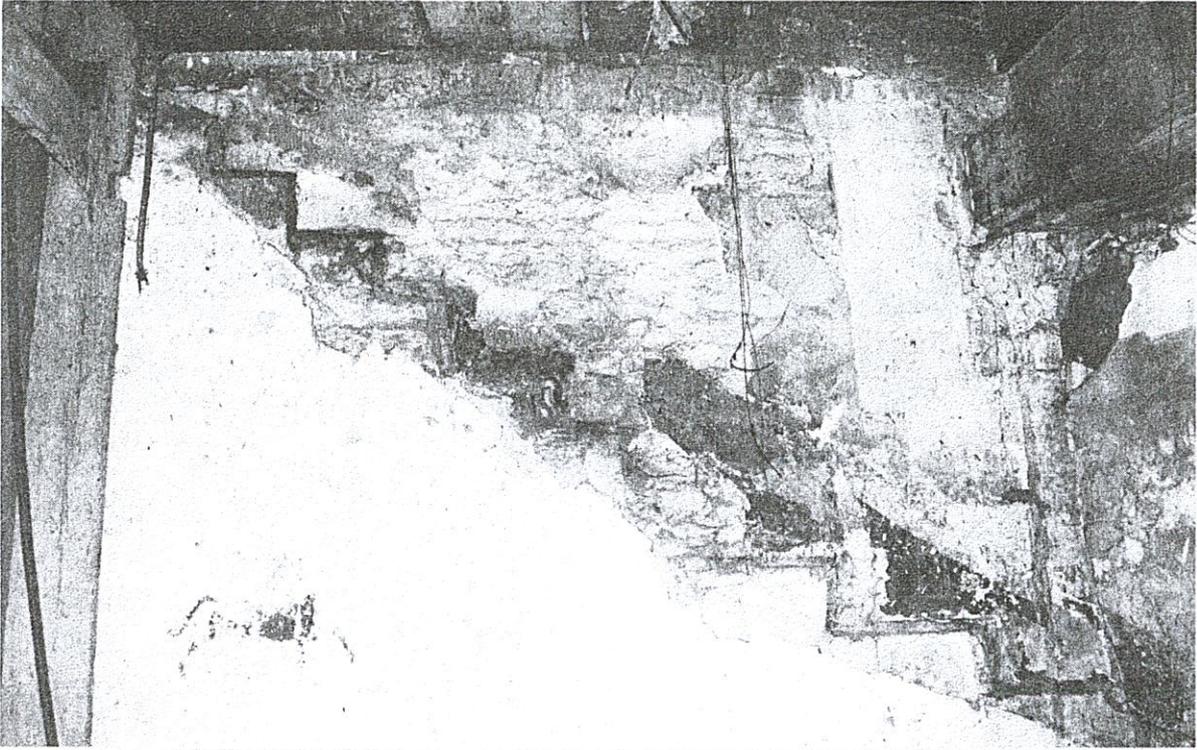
Dans une pièce se situant à l'Est de la précédente. Représentation d'un cavalier sous un ancien escalier. À droite une poutre d'origine et son pilastre partiellement recouvert par une cloison.
